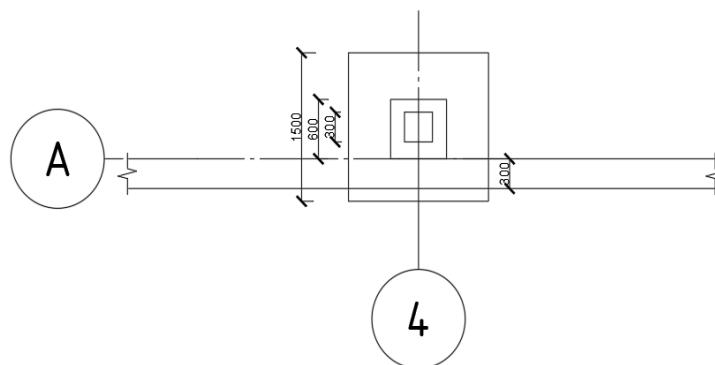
Схема столбчатого фундамента Ф-1, вид сверху.
